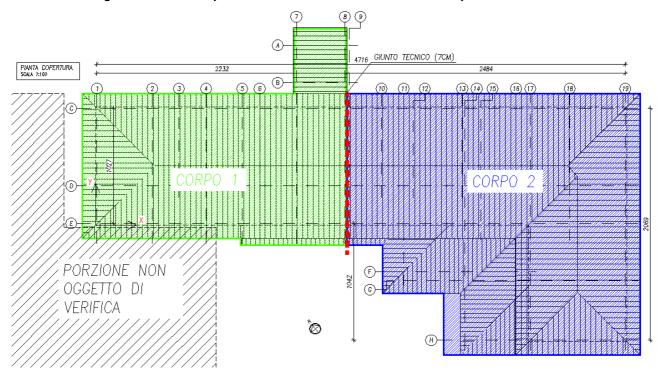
Pianta della copertura con l'identificazione dei due corpi strutturali distinti
